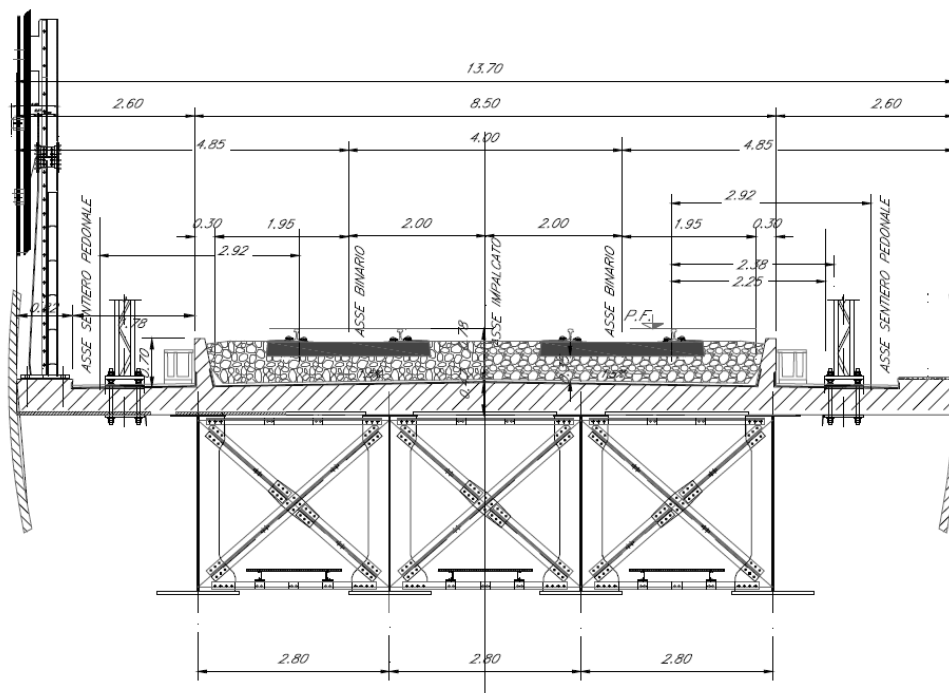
Sezione tipo dell'impalcato a struttura mista acciaio calcestruzzo a doppio binario
